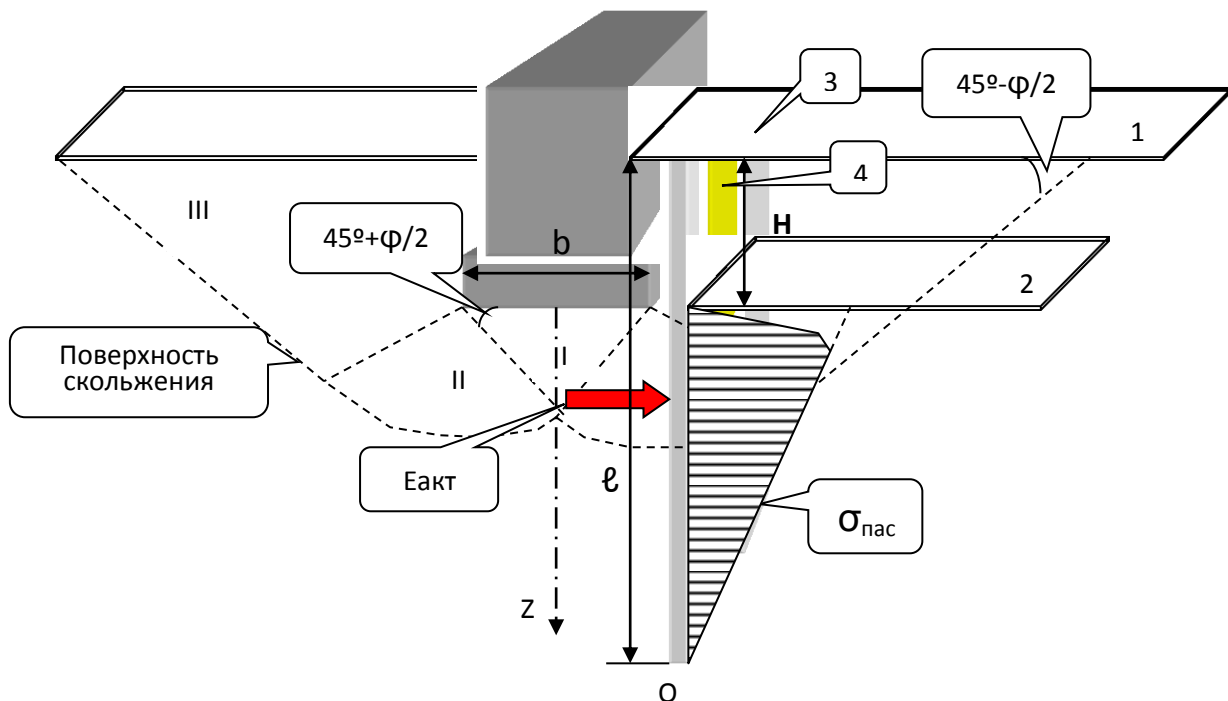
Расчётная схема формирования предельного состояния от ленточного фундамента для основания усиленного конструктивным разряженным шпунтом.
